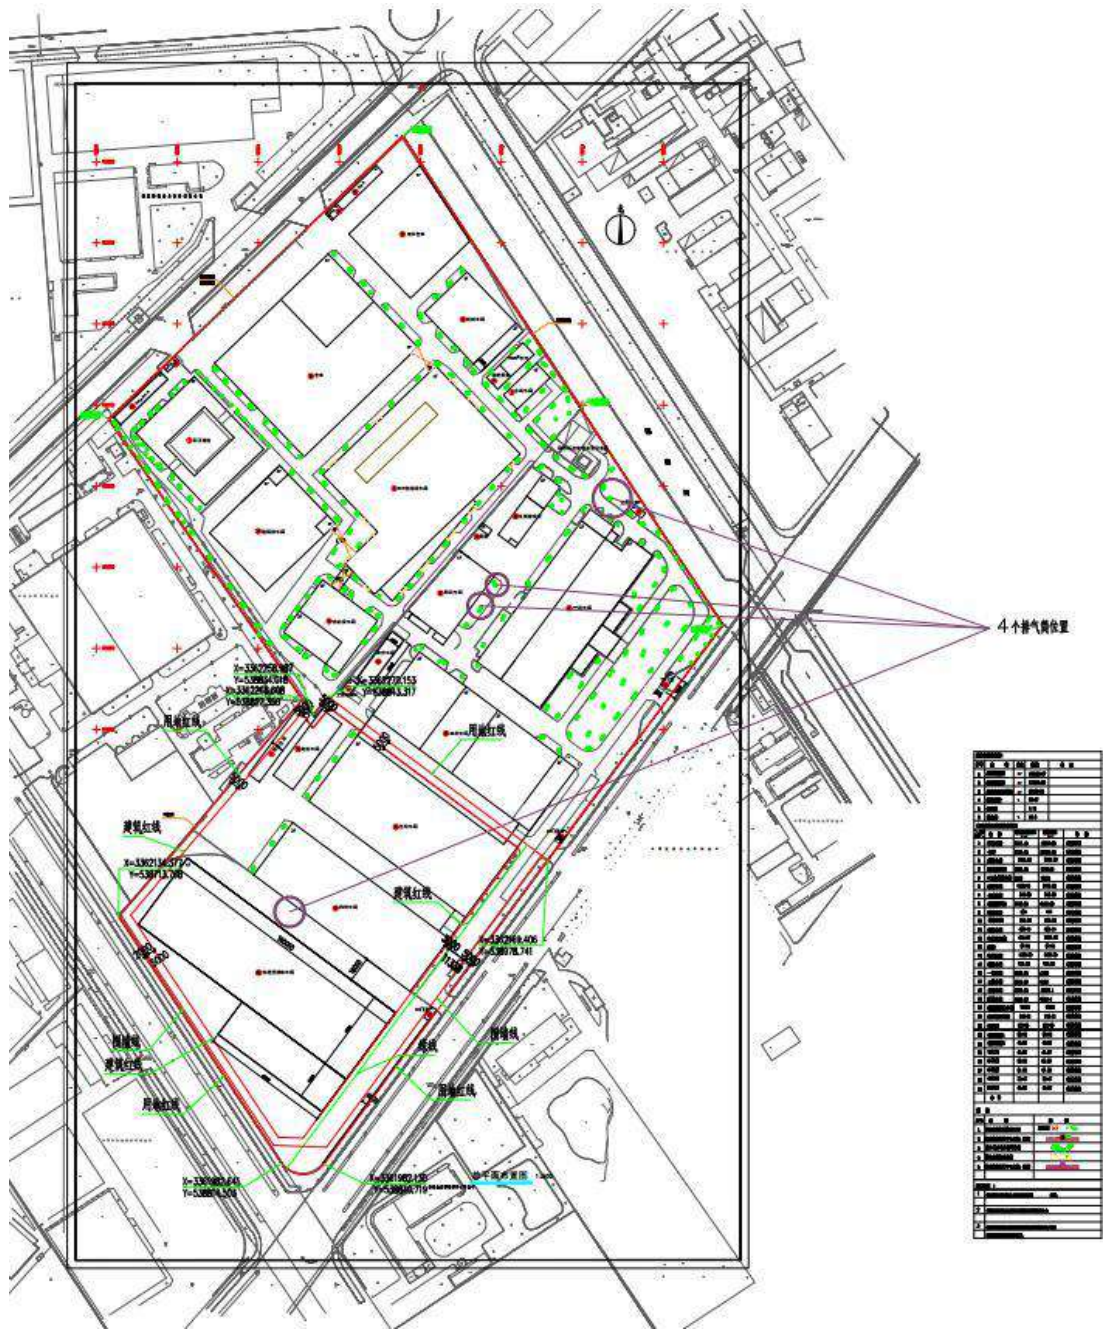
地块平面布置图及重点区域（对比图）
